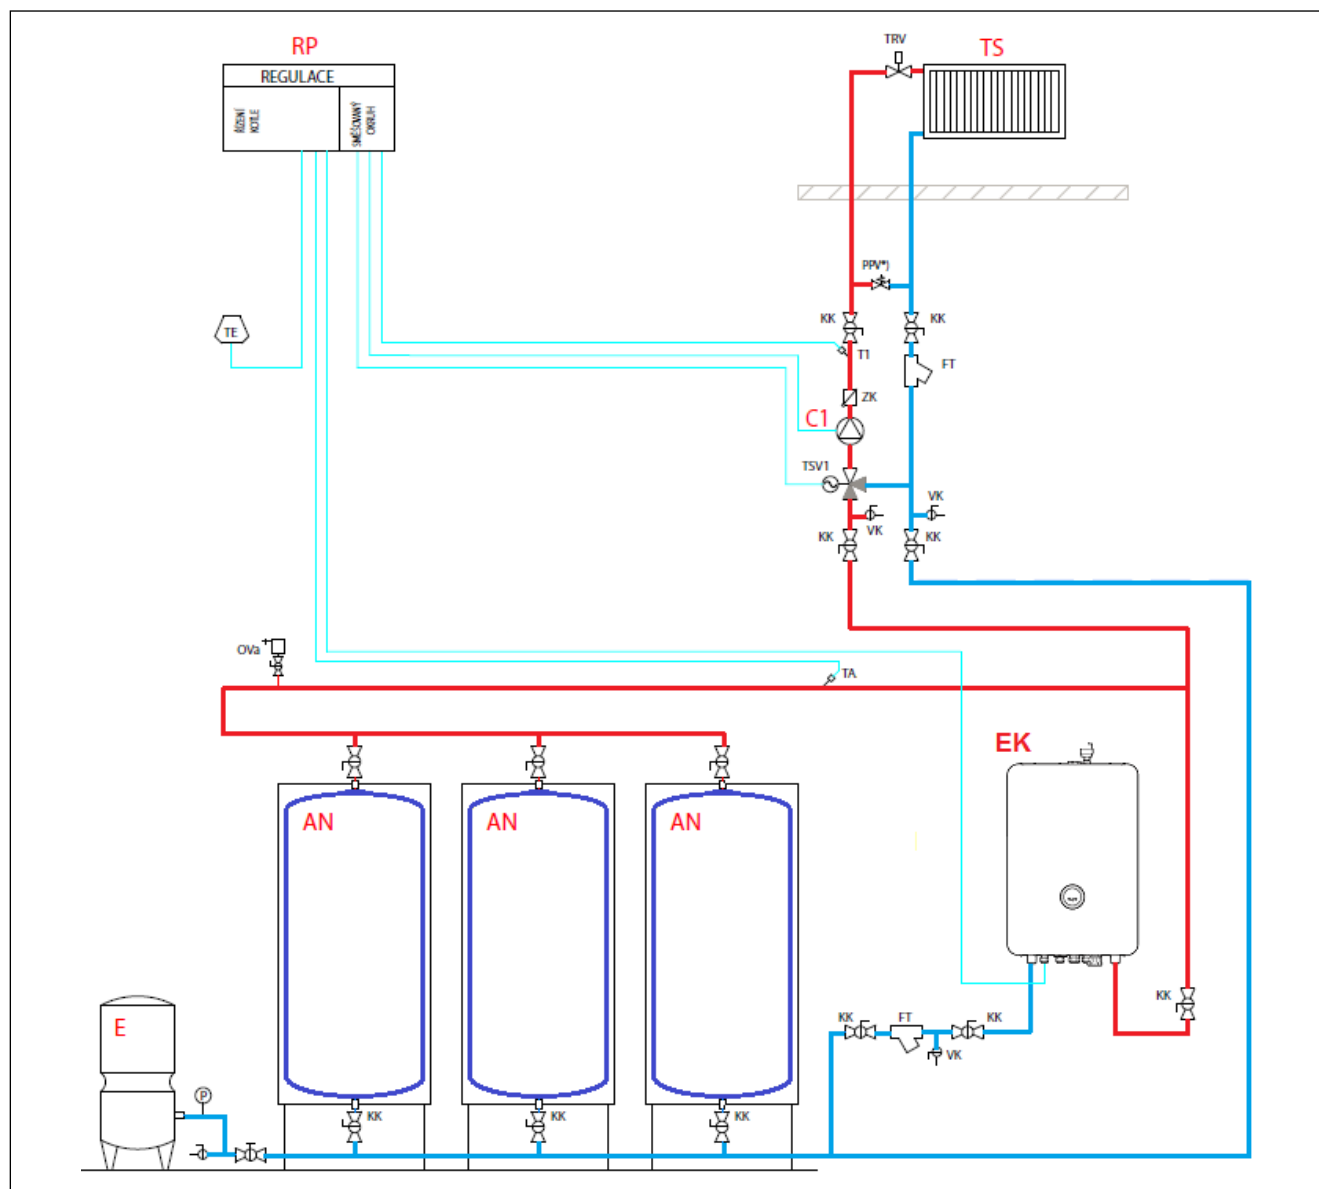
Zapojení elektrokotle jako záložního zdroje tepla pro otopnou soustavu
